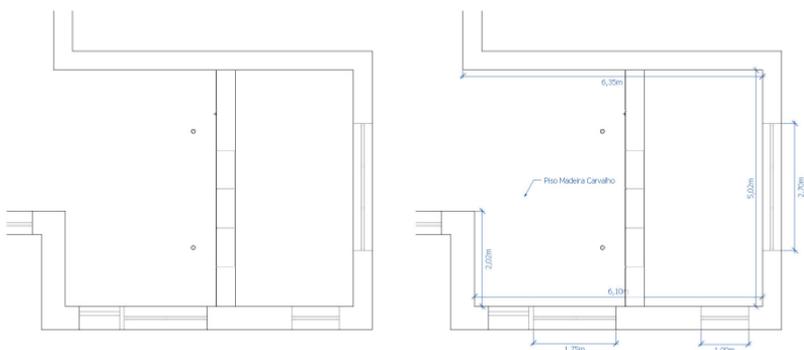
| Vista de elevação com cotas e textos aplicados
